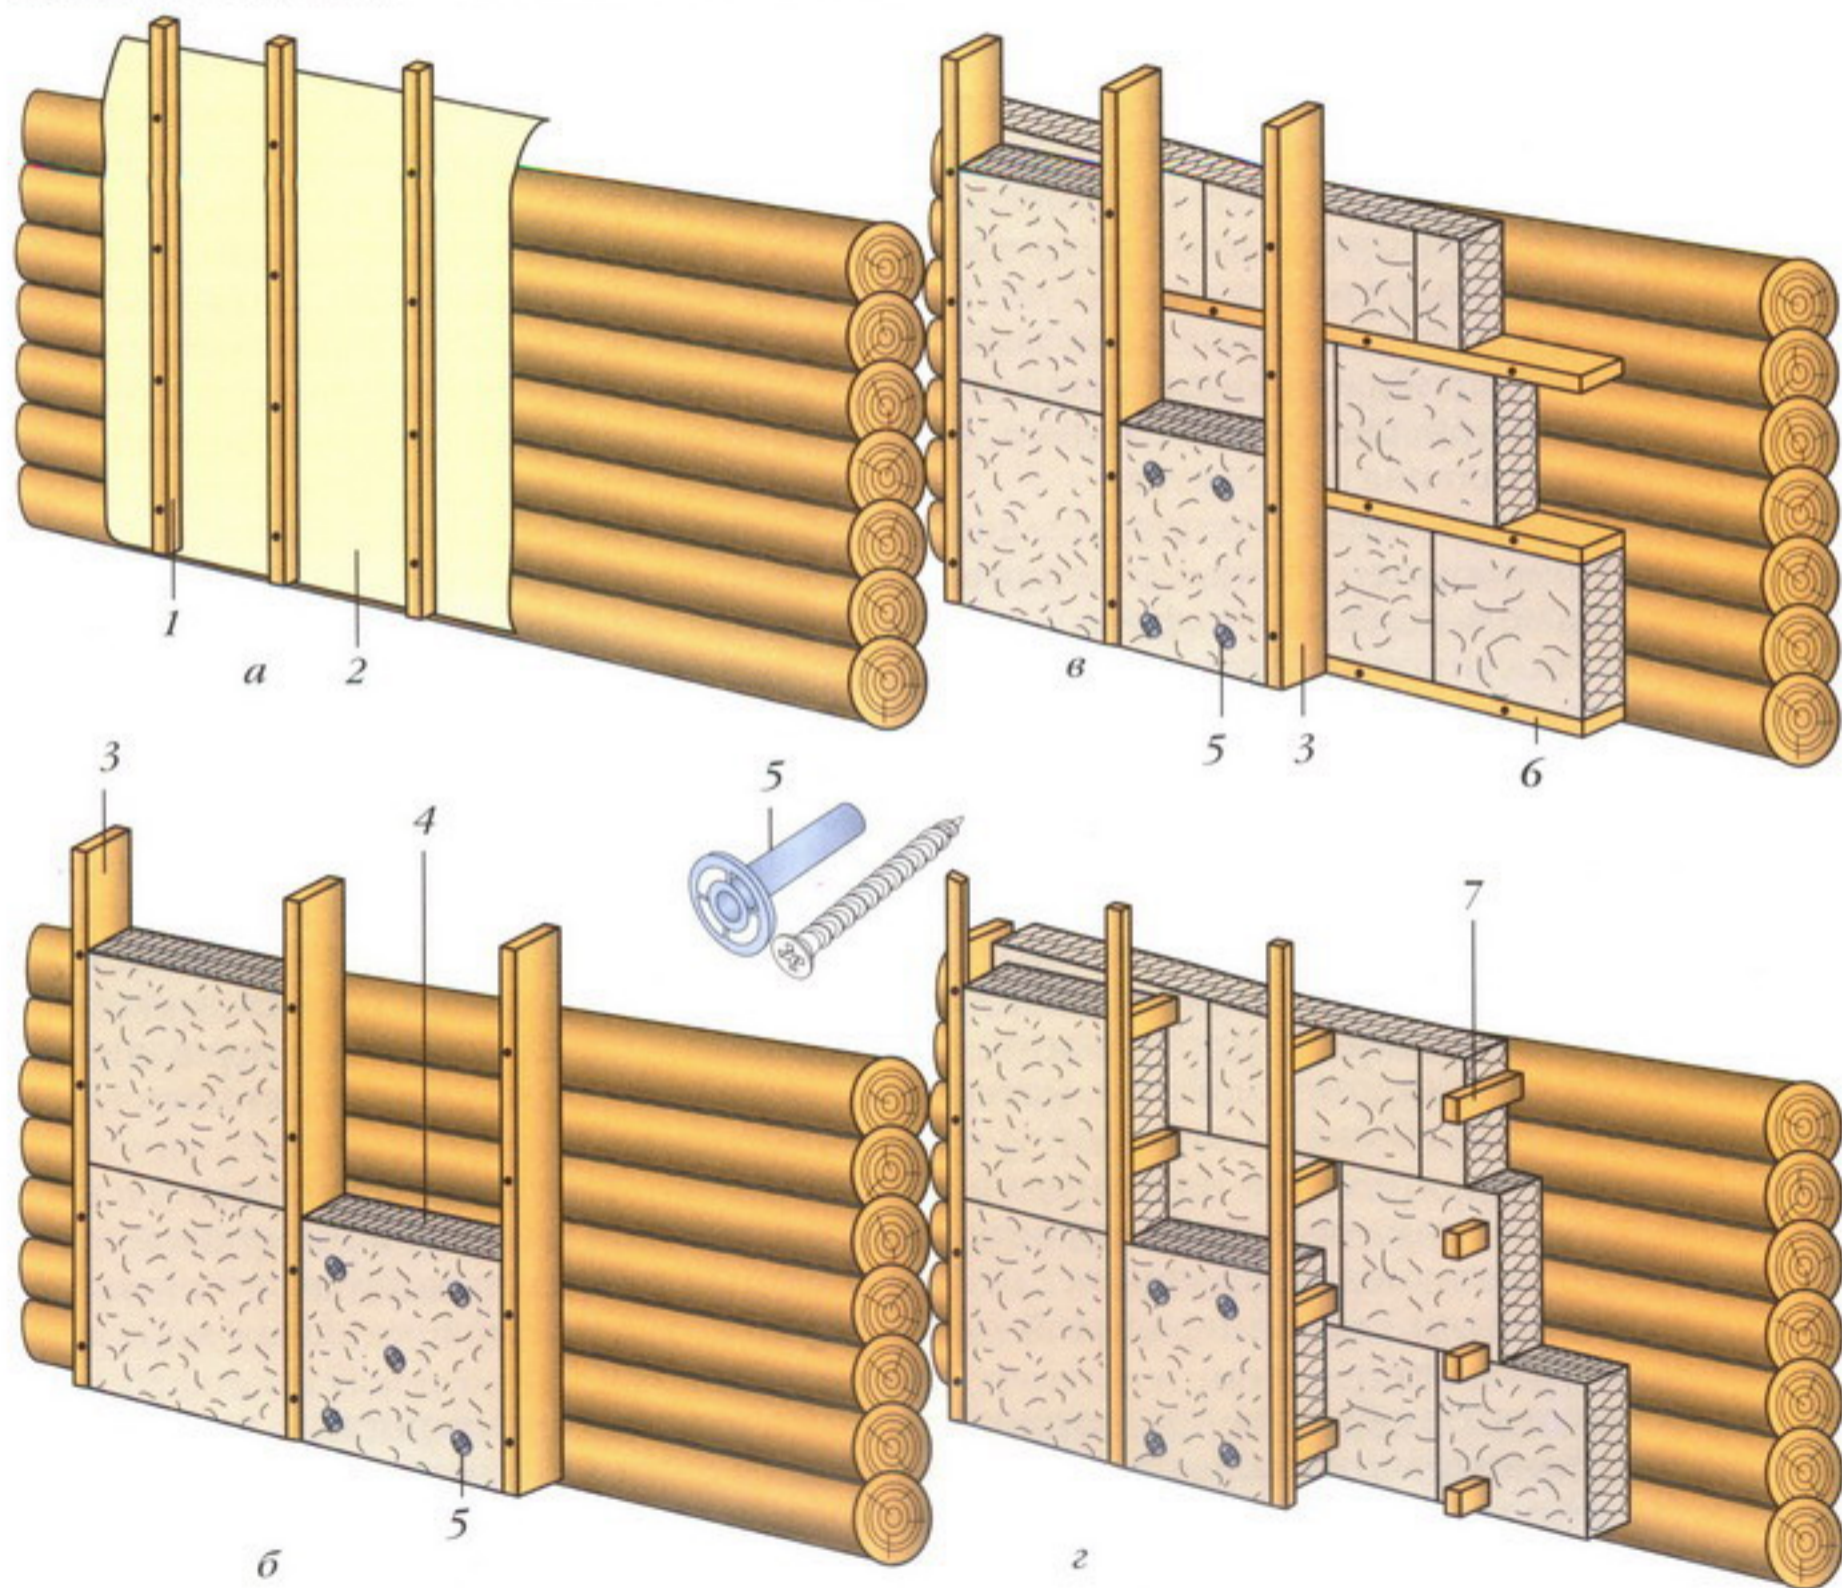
Утепление стен: а — рулонным утеплителем; б — межкаркасное в один слой; в — то же, в два слоя; г — бескаркасное в два слоя; 1 — обрешетка; 2 — рулонный утеплитель; 3 — вертикальный каркас; 4 — плитный утеплитель; 5 — грибок; 6 — горизонтальный каркас; 7 — коротыши
